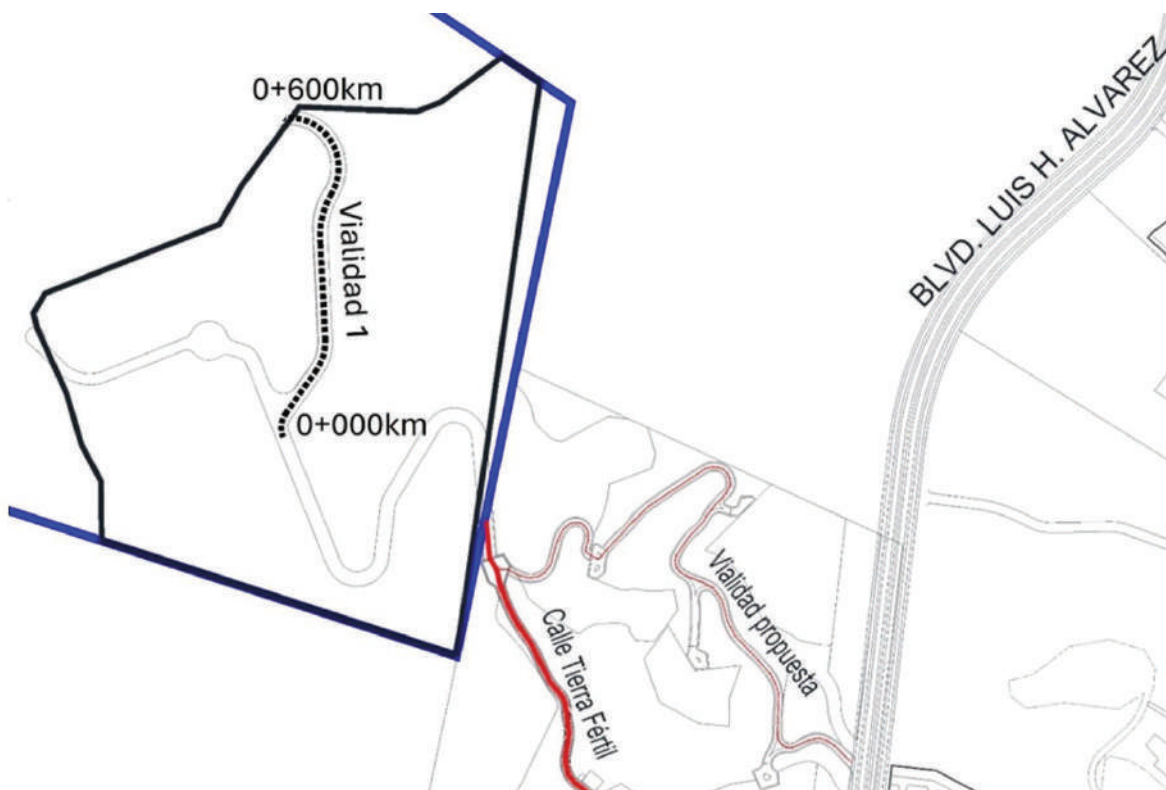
Propuesta Vialidad 1. Fuente. Elaboración propia.
